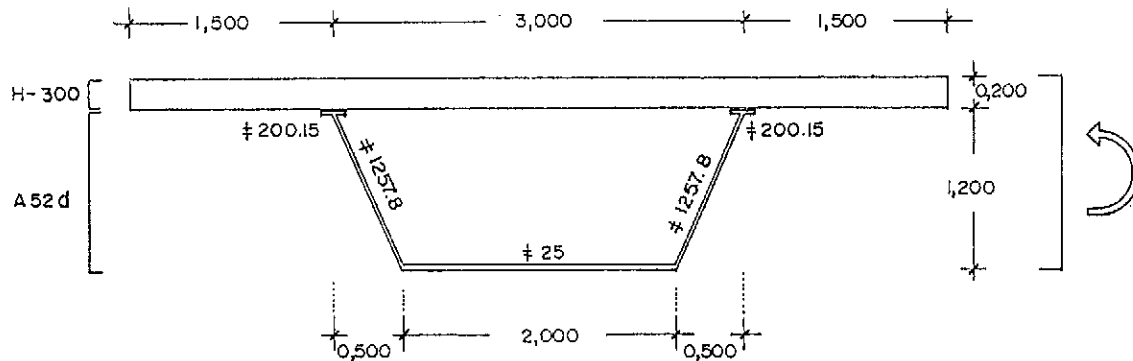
Sección esquemática de un cajón mixto hormigón acero estructural solicitado en flexión pura "positiva".
